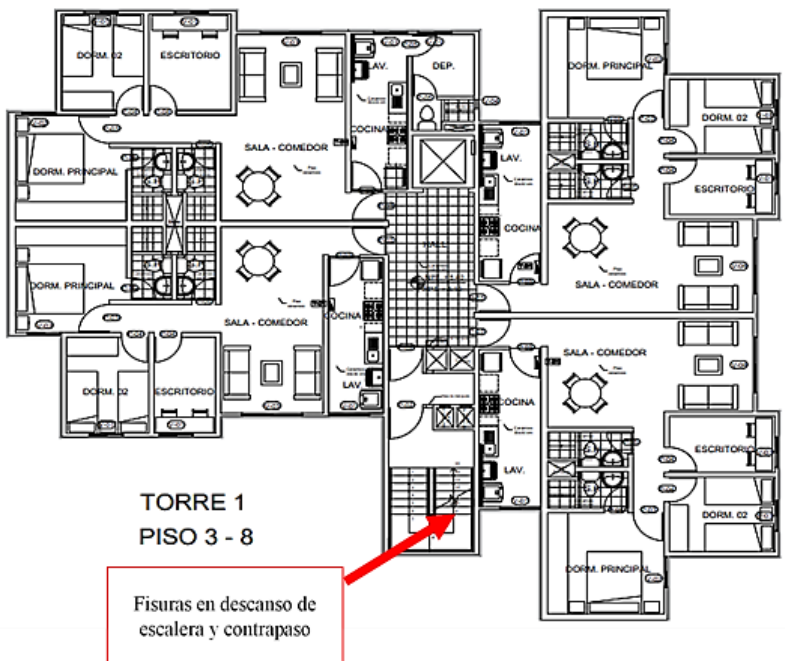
ubicación de fisura entre descanso de escalera y contrapaso del edificio 1 – tramo 2do y 3er nivel.
